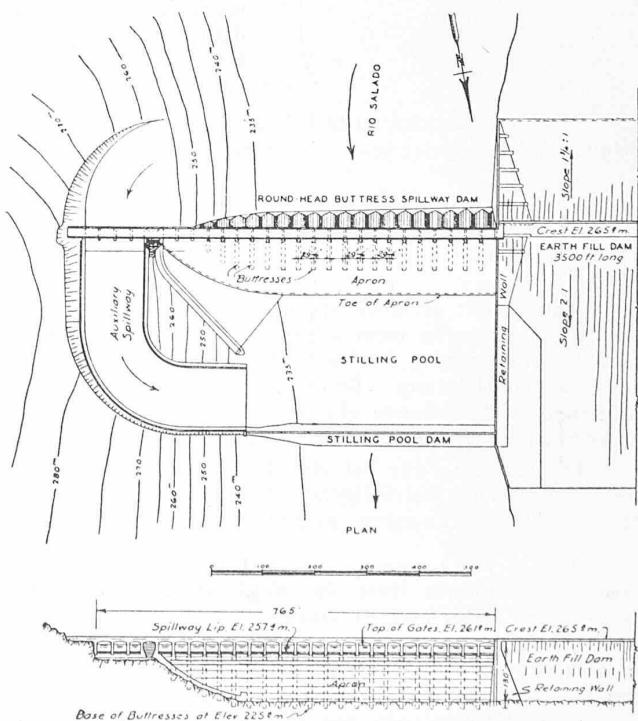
Grundriss und luftseitige Ansicht. — 1 : 4000.
